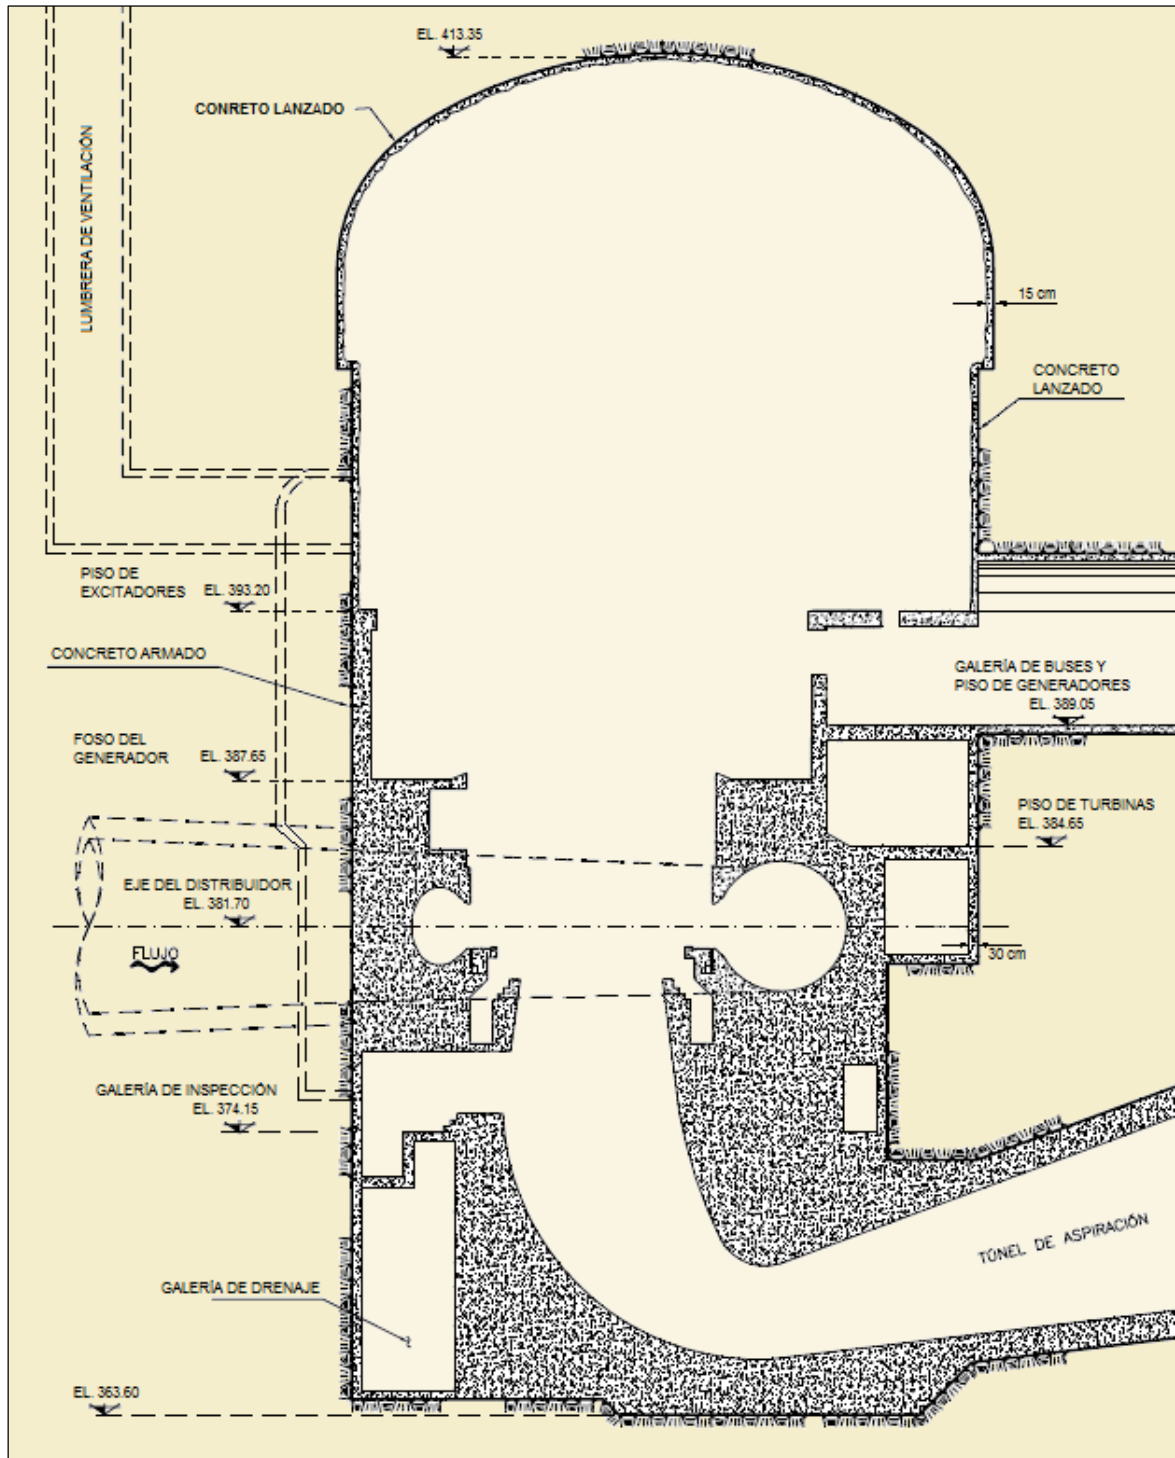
Sección transversal de la Casa de Máquinas de la C. H. La Yesca, revestimiento definitivo con concreto armado colado en el sitio y concreto lanzado en la parte superior.
